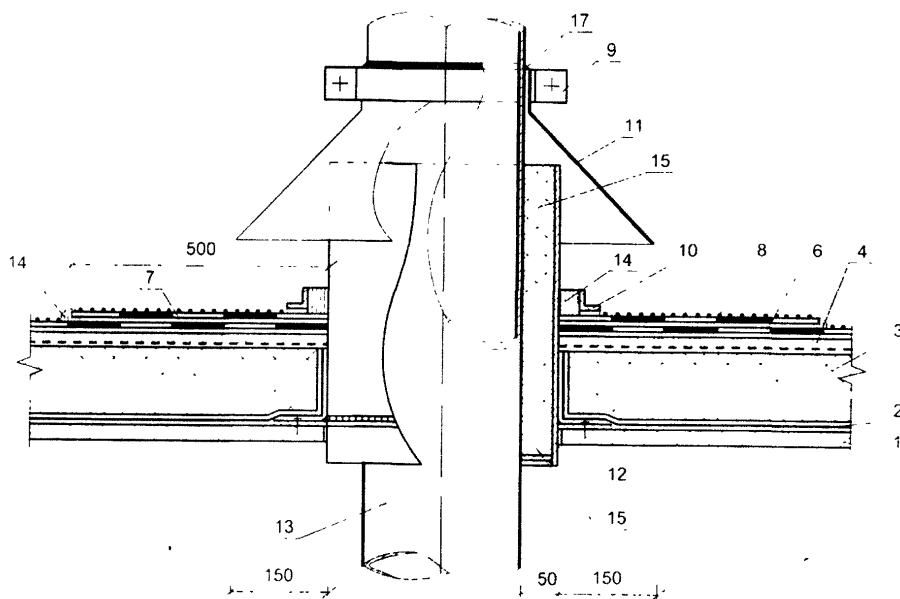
Пропуск трубы через покрытие с традиционной кровлей.
